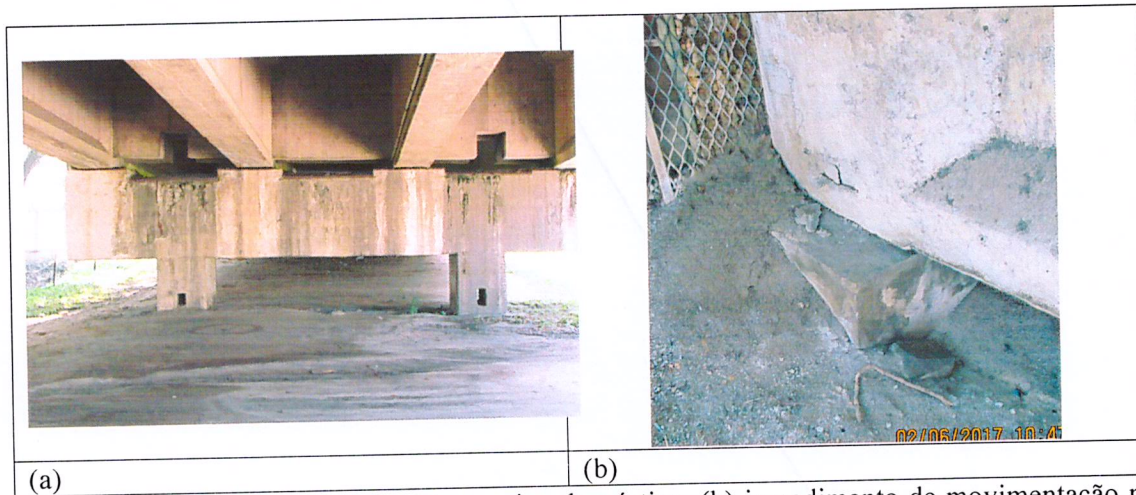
(a) acúmulo de detritos sobre a viga do pórtico, (b) impedimento de movimentação na articulação;
